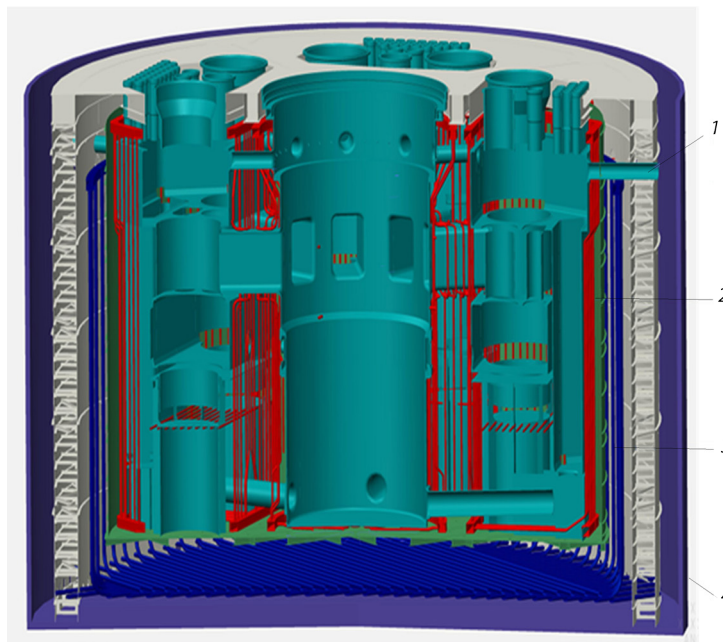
Схема металлобетонного реакторного корпуса:
